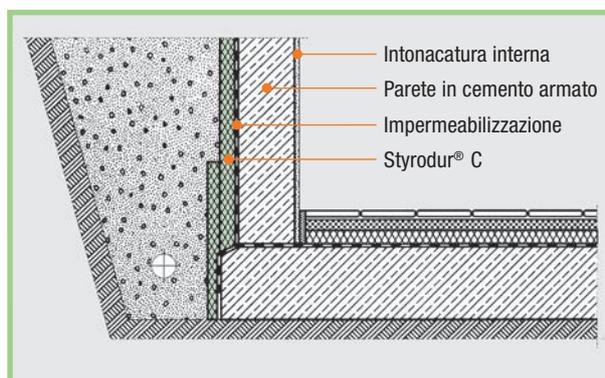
Punto inferiore dell'isolamento perimetrale. La lastra di Styrodur® C è posizionata verticalmente sulle fondamenta.
